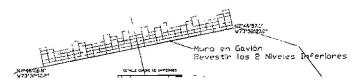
Planta del muro gavión al margen derecho de la Quebrada San Albertico⁷.
